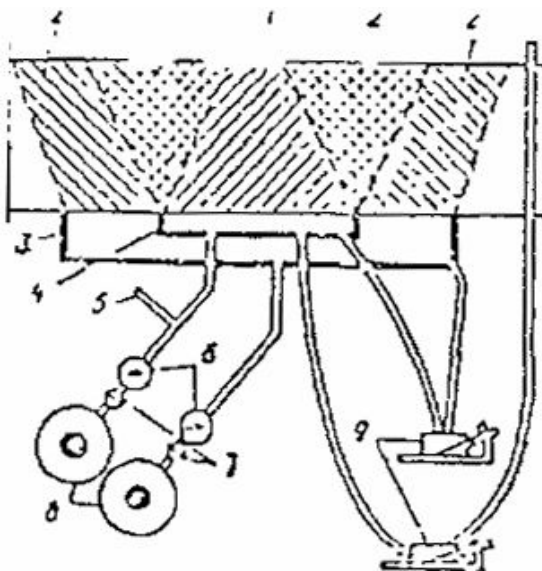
Схема установки для испытания стены на воздухопроницаемость
